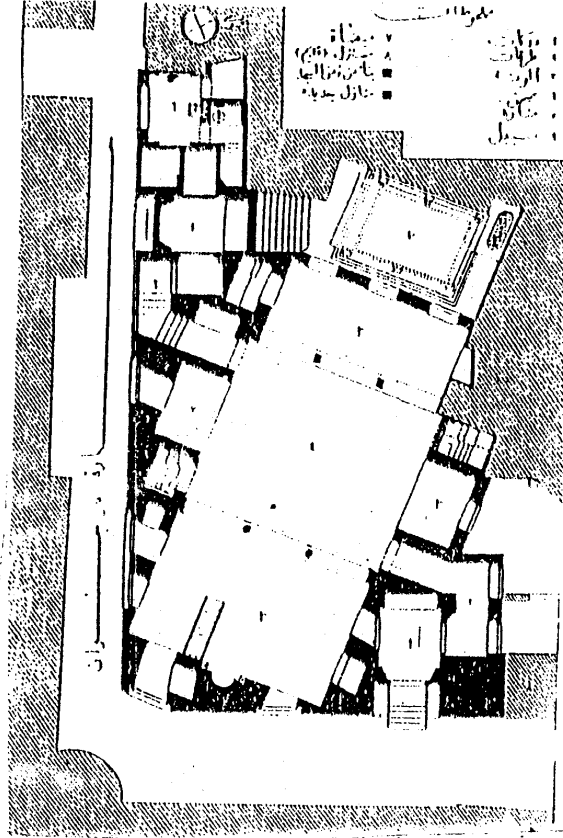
مسقط أفقي لخانقاة الأشرف برسباي (بقرافة صحراء المماليك) بالقاهرة .
